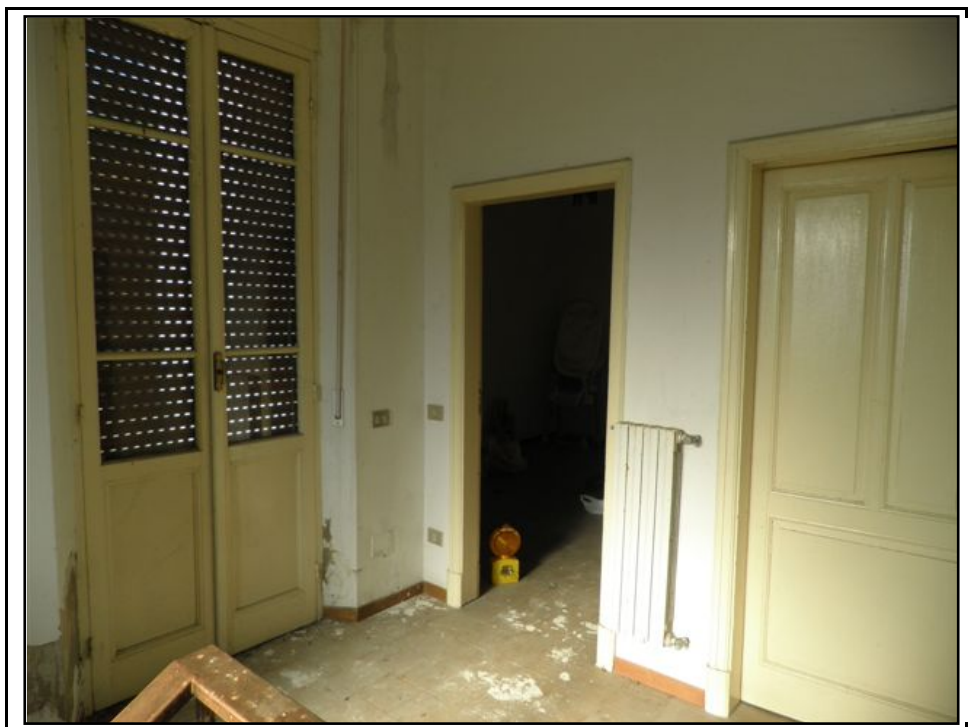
Piano Primo. Disimpegno con porta-finestra su terrazzo
